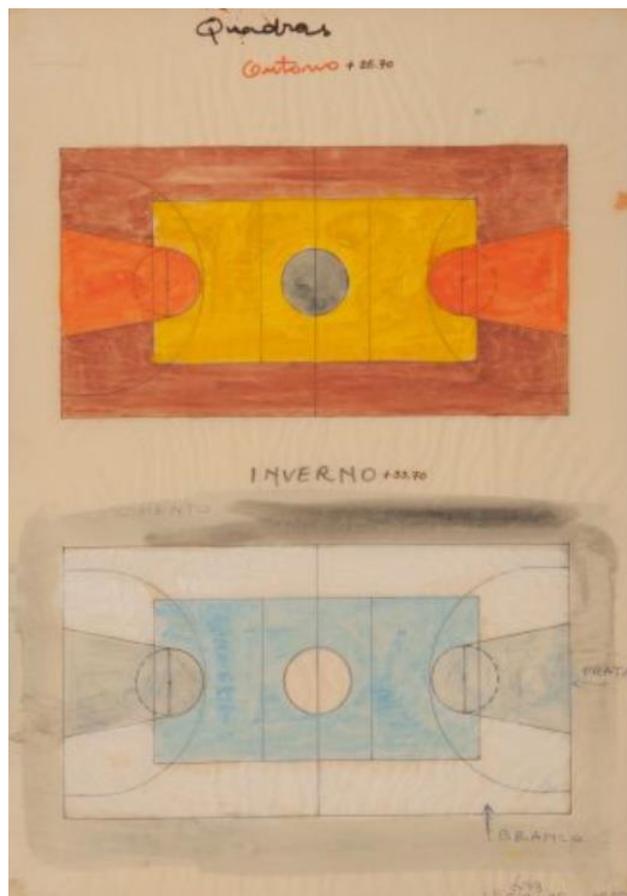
planta de las pistas deportivas Otoño e Invierno, Lina Bo Bardi, 1977, archivo Instituto Bardi
